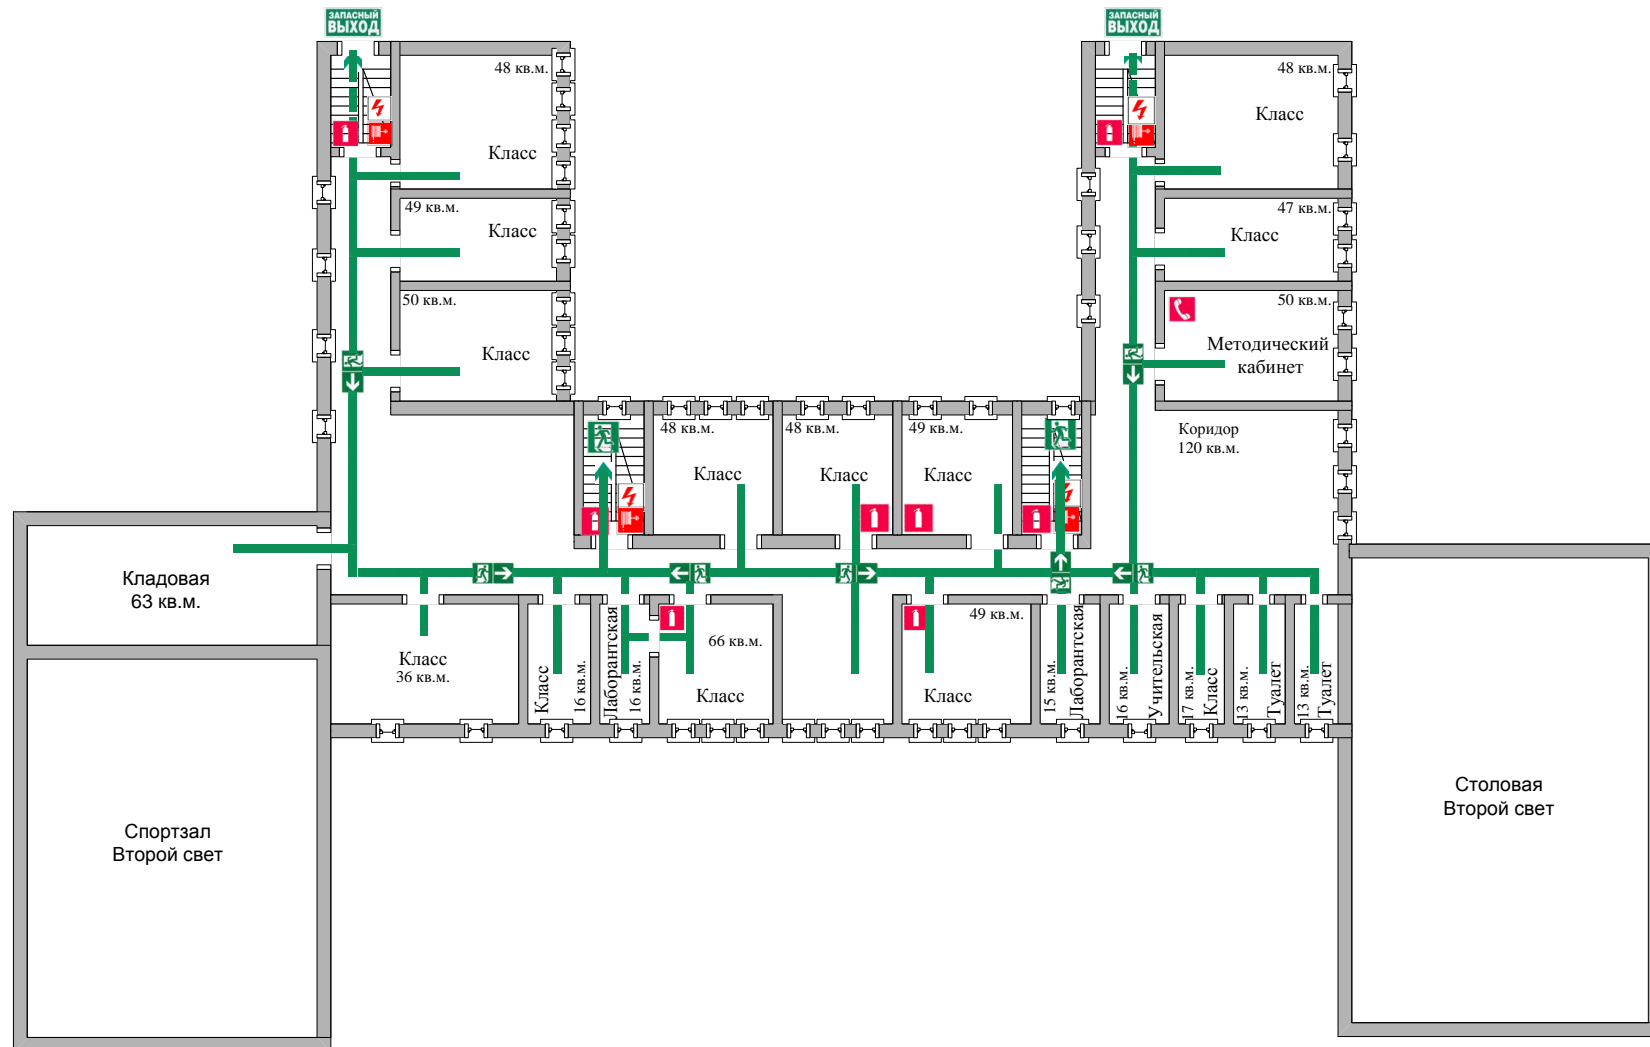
Схема помещений 2-го этажа гимназии
